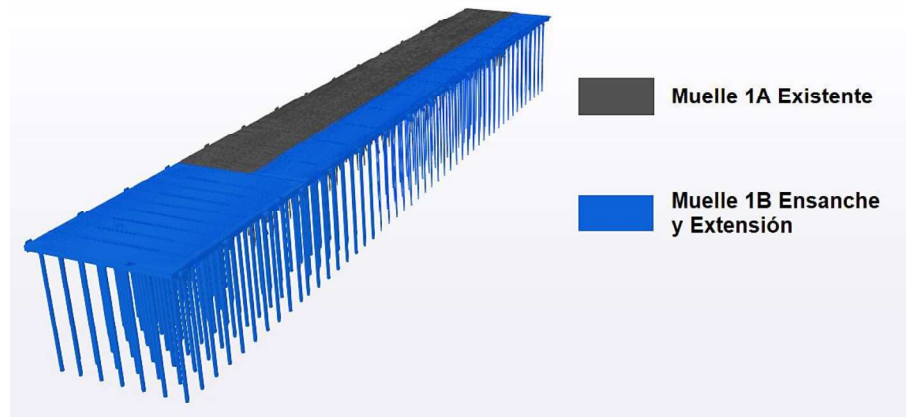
Diseño inicial de construcción de Muelle 1 (Compuesto de 1A y 1B). Elaboración propia
